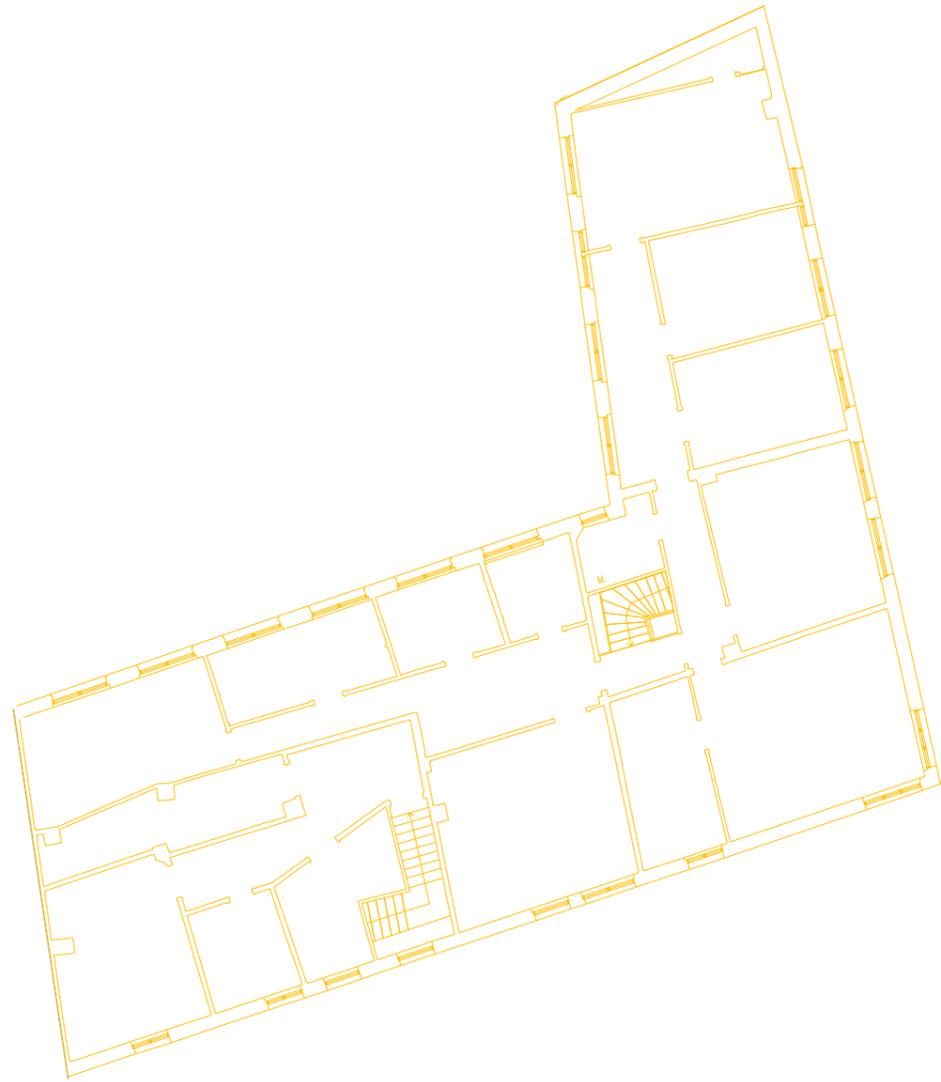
Hinterhofremise, mögliche Rückbaumaßnahmen, Erdgeschoss M 1.200
